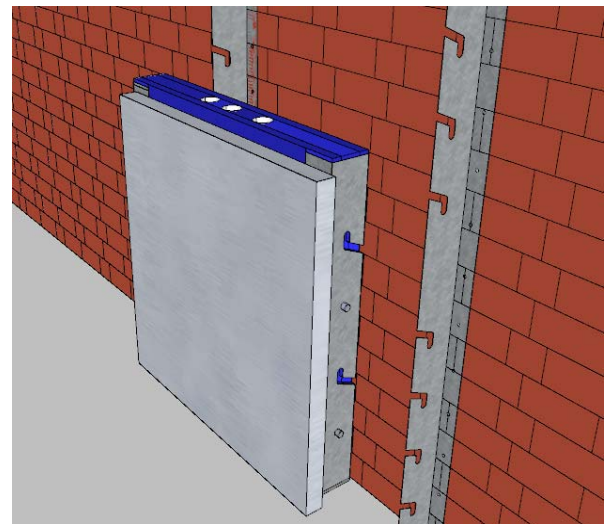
Anschlusslösung für Dachmodul (Flachdach oder Steildach) [09]
